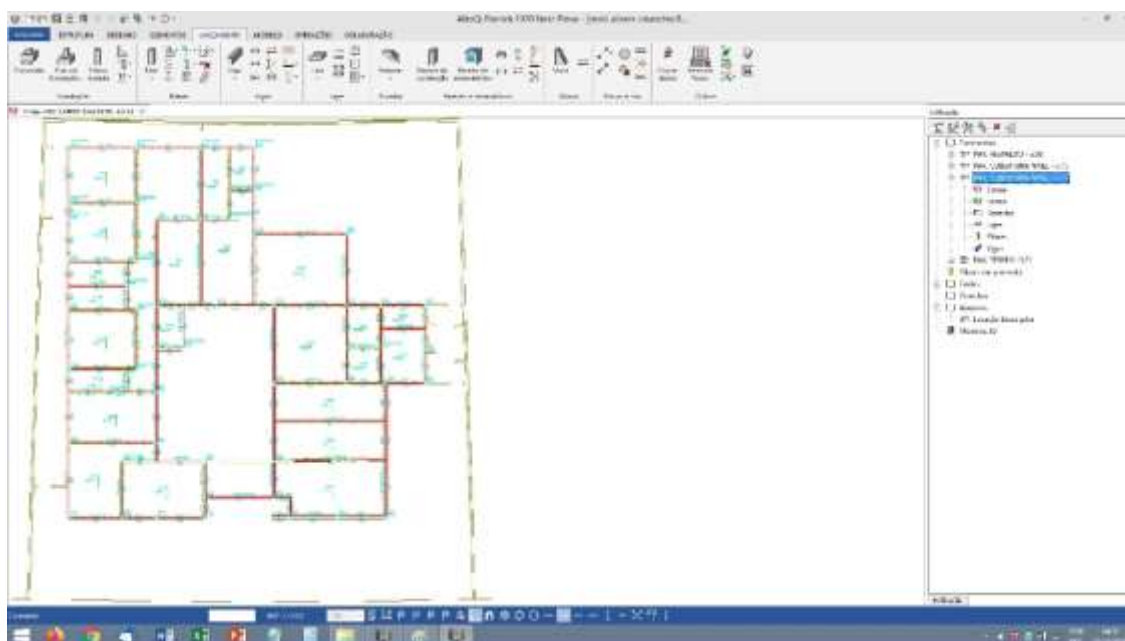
Planificação do arquivo IFC com geração das plantas de Arquitetura
